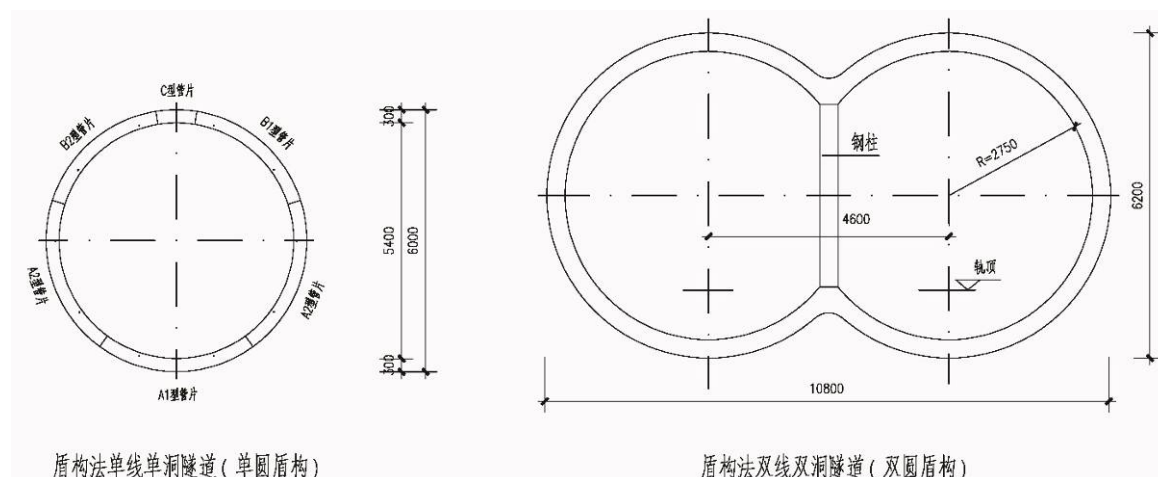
隧道区间圆形横断面示意图（单位 mm）
